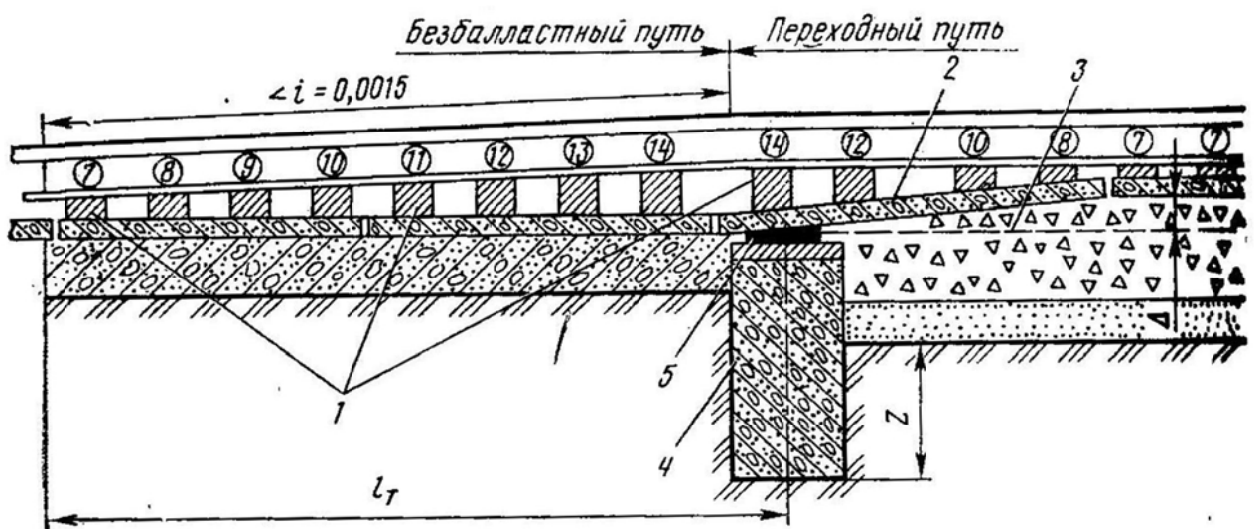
Конструкция УПЖ с применением железобетонных плит переменной ширины
